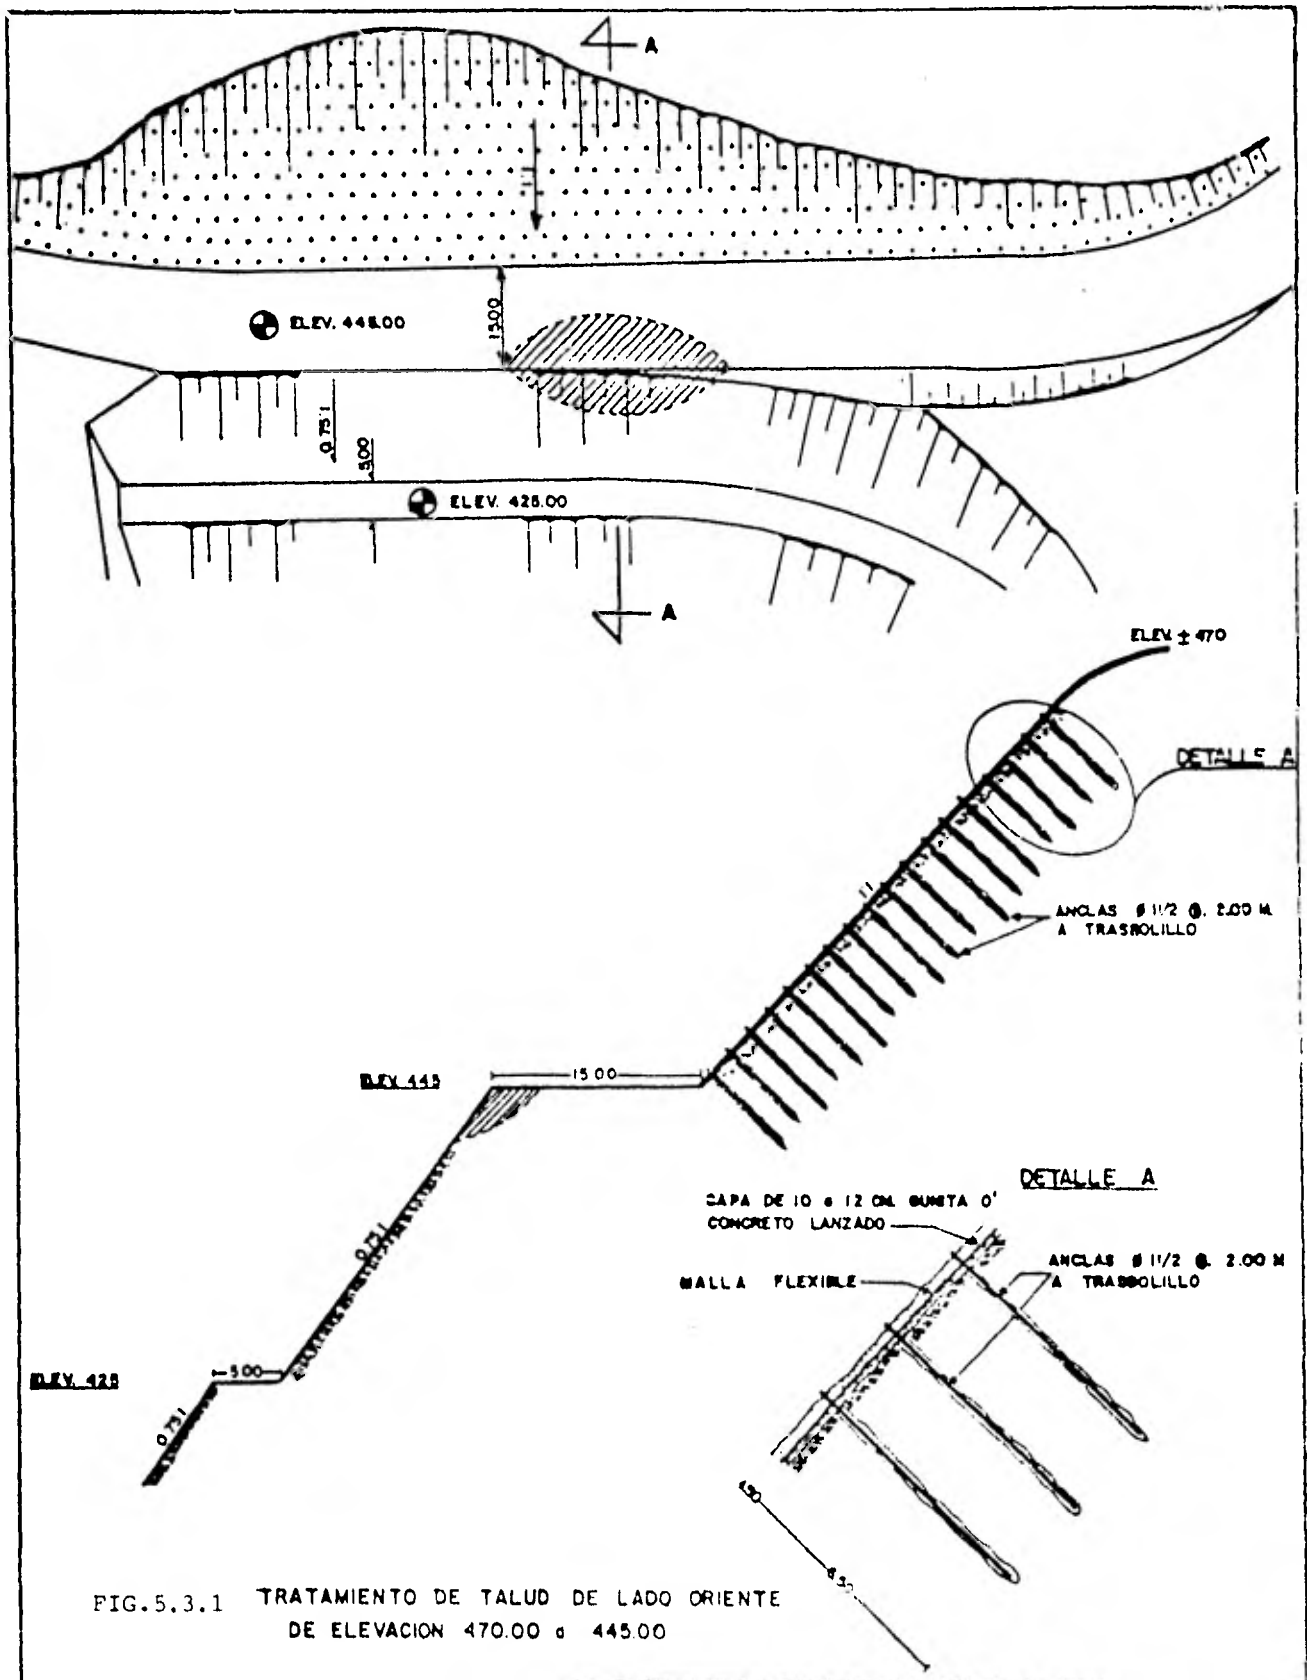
TRATAMIENTO DE TALUD DE LADO ORIENTE DE ELEVACION 470.00 a 445.00
